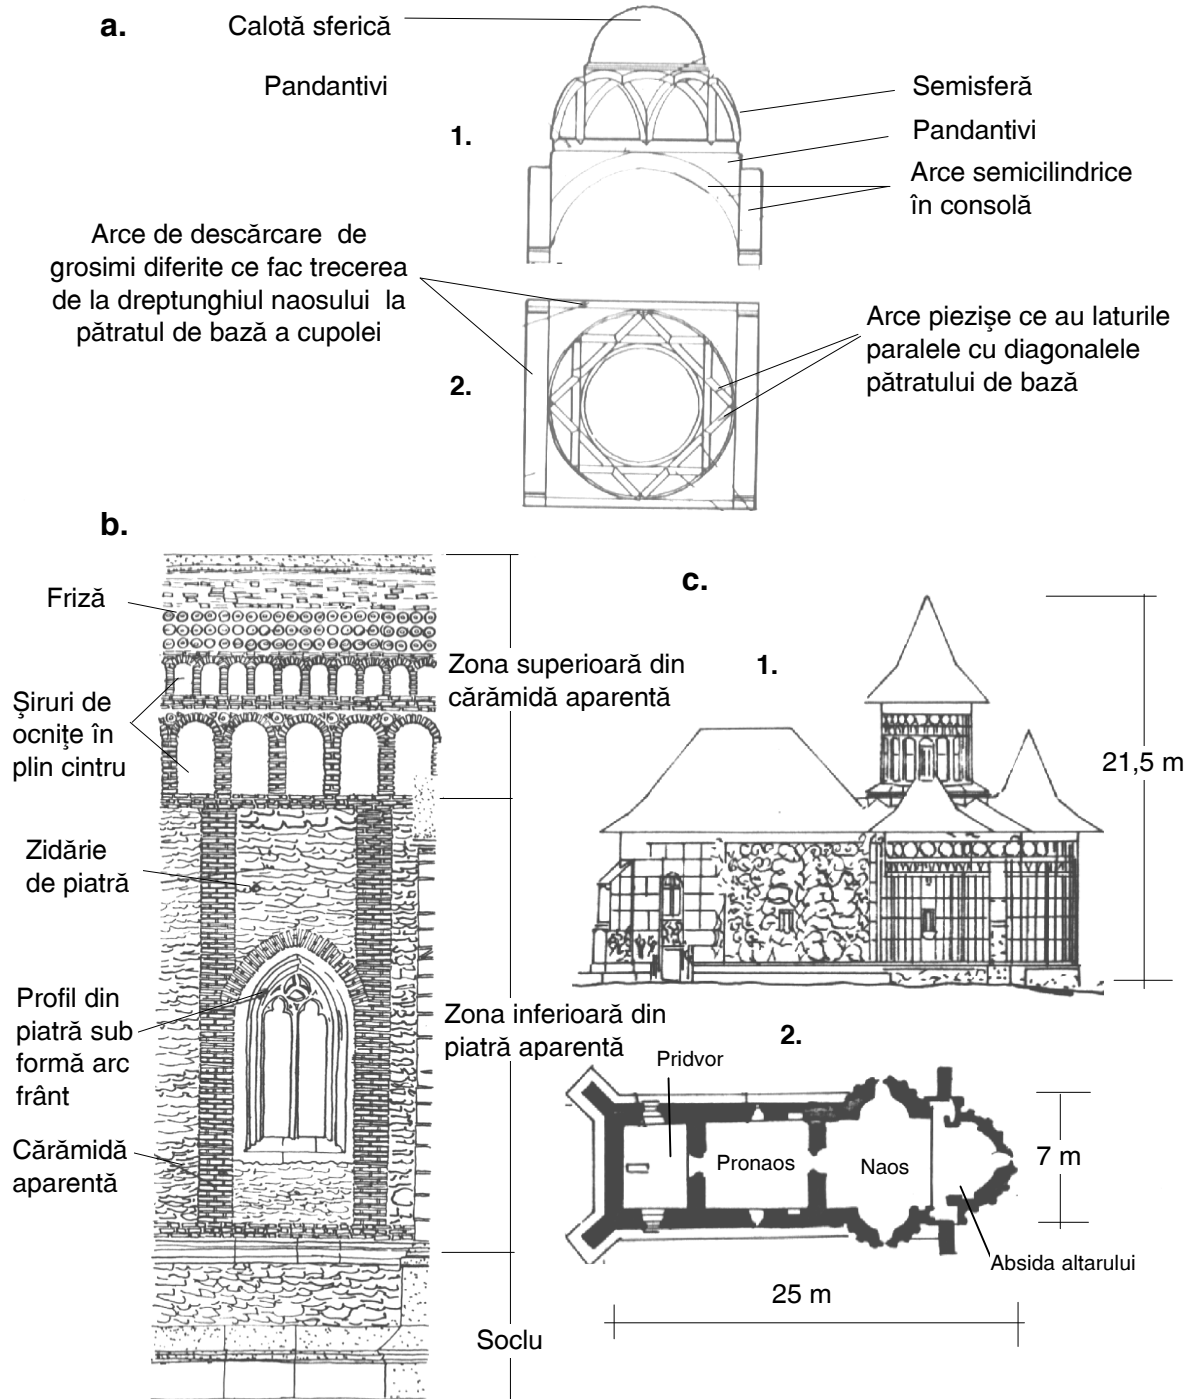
Mănăstirile din Moldova. a (1,2). Sisteme de boltire. b. Detaliu fațadă. c (1,2). Fațadă. Plan.
